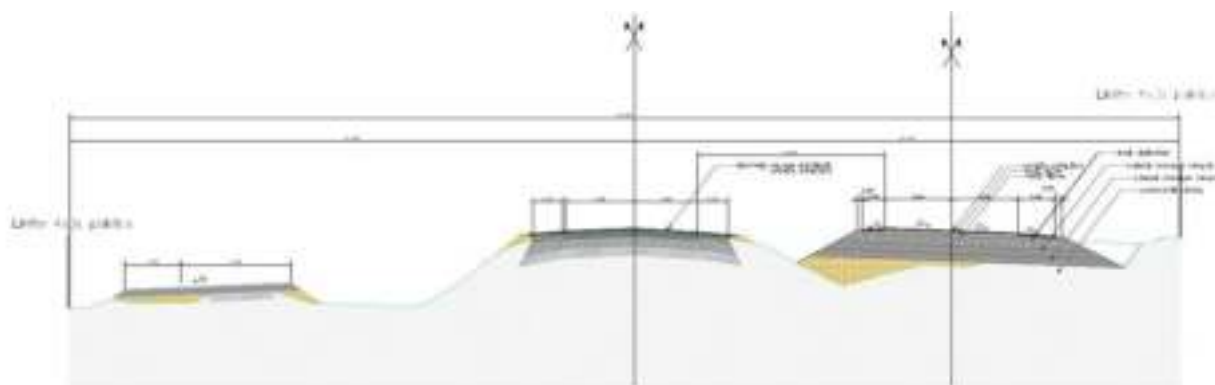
Perfil Tipo V con cantero central y calzadas de servicio a un lado.
